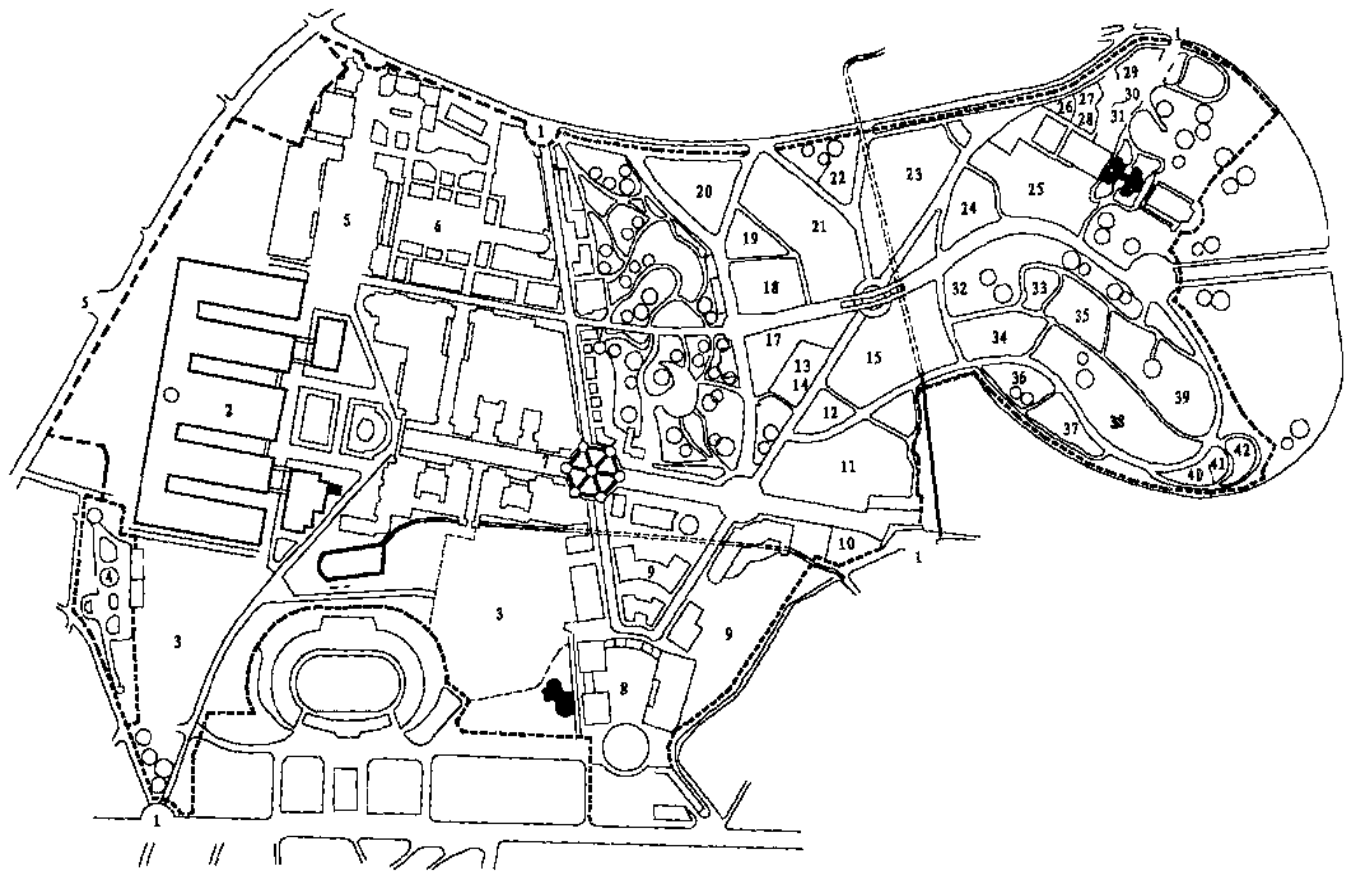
1981年日本神户人工岛世界博览会总平面图
